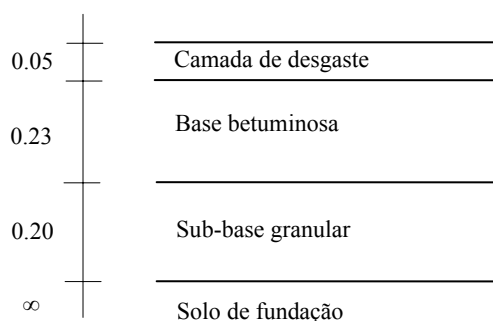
Estrutura do pavimento do primeiro caso de estudo
